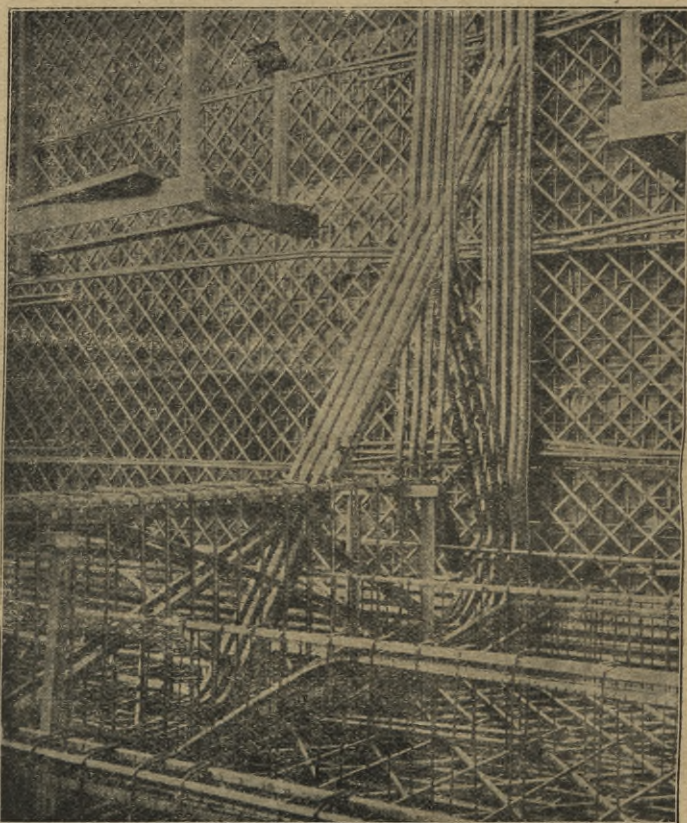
Eisenbetonschiff von 7900 Tonnen, Bauweise Alan Mac Donald und Kahn. Bewehrung der Spanten und der Haut.
